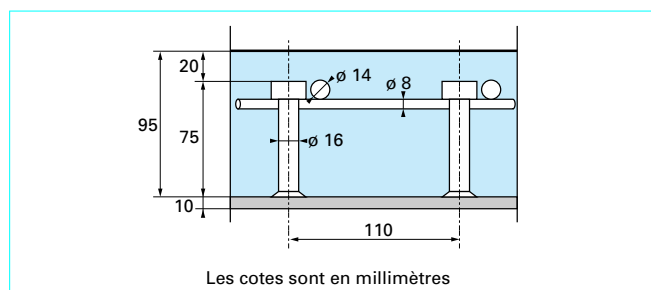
Principe de la dalle mixte avec une connexion par goudjons
